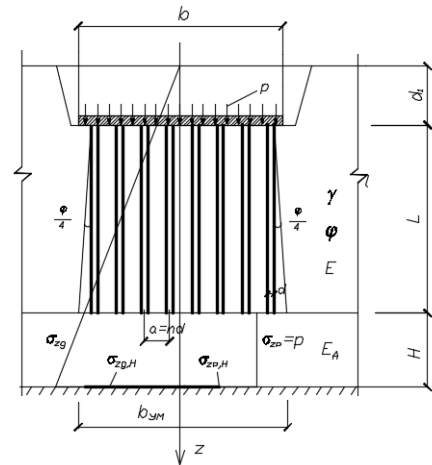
Розрахункова схема взаємодії ПСПП фундаменту з ґрунтовою основою
